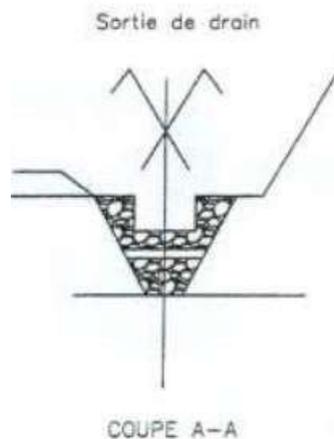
PROFIL EN TRAVERS DE DRAIN
